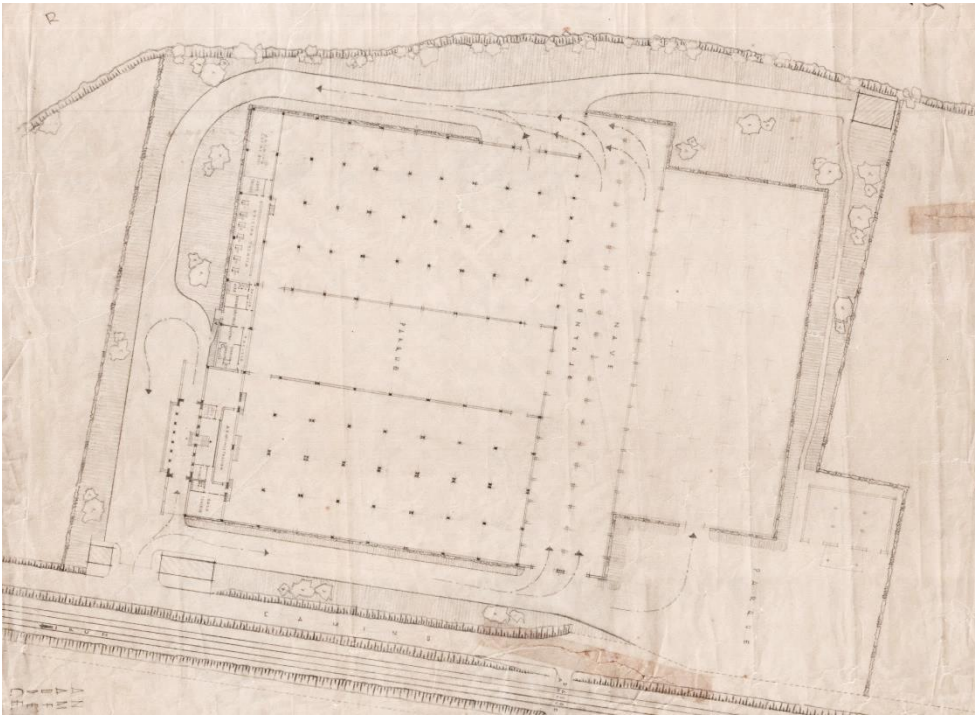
Planta general del proyecto de ampliación. (AMV 1956a)
